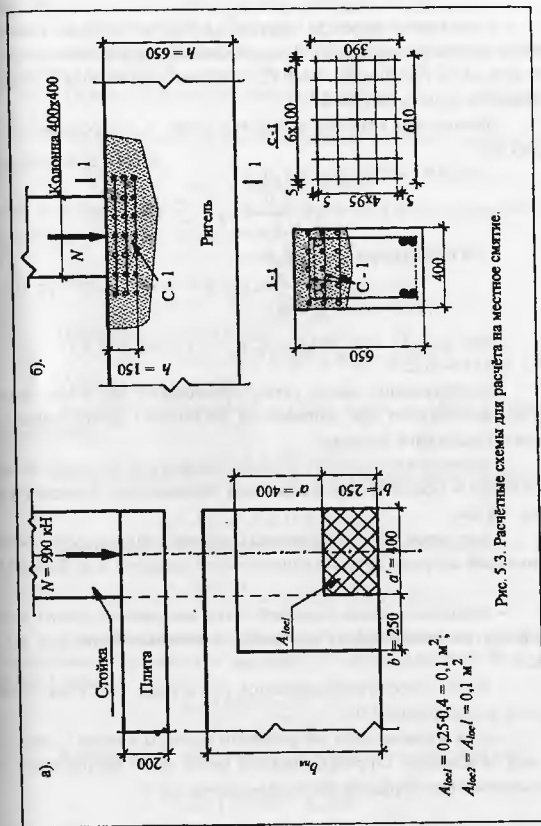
Расчётные схемы для расчёта на местное сжатие.
